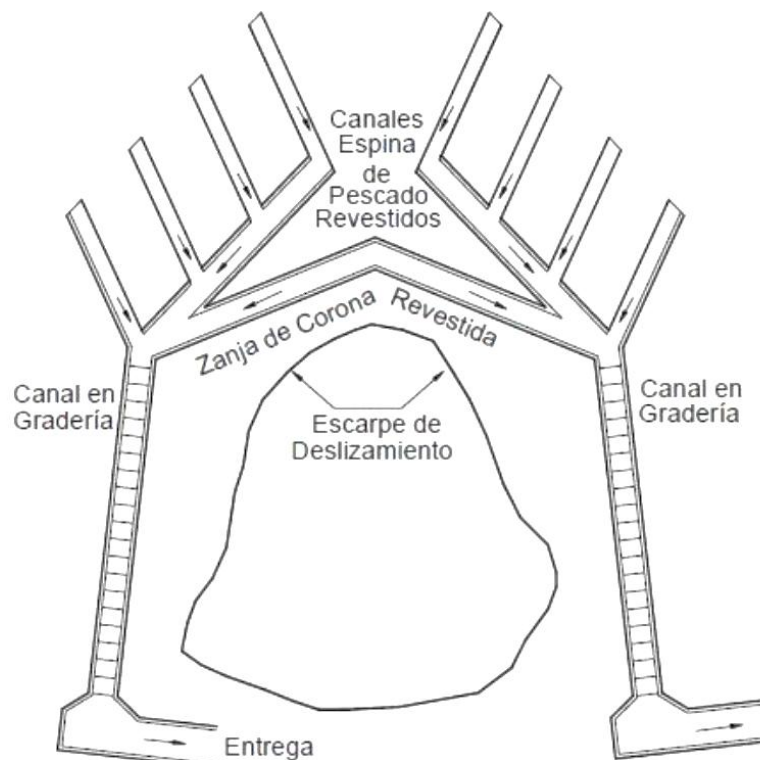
Esquema en planta de canales colectores Espina de Pescado. (Suarez, J. 2010).
